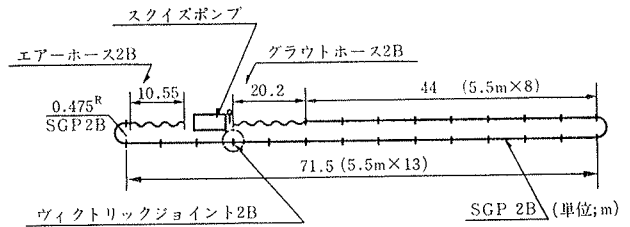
ゲル混合土のポンプ圧送実験用配管平面図
